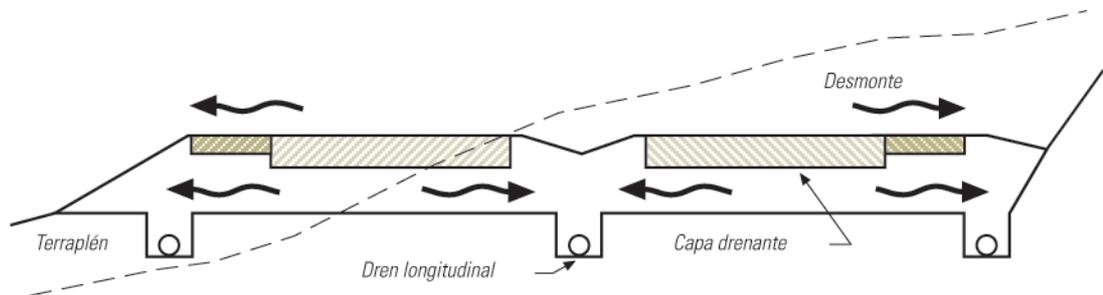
Sección transversal de capa drenante por eje de dren transversal
